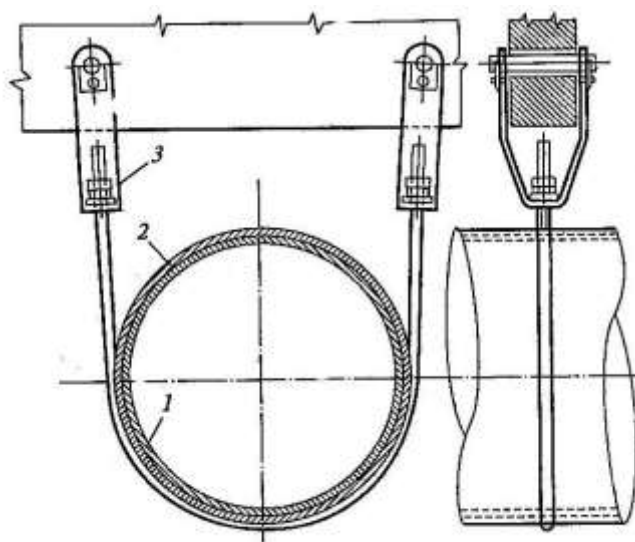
Подвеска газопровода под железобетонным мостом:
